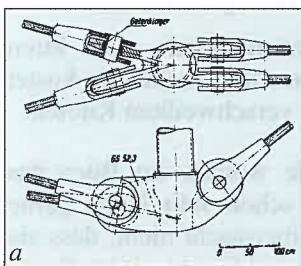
Olympiadach München, 1972. Stahlgussknoten unter einer „Luftstütze“
